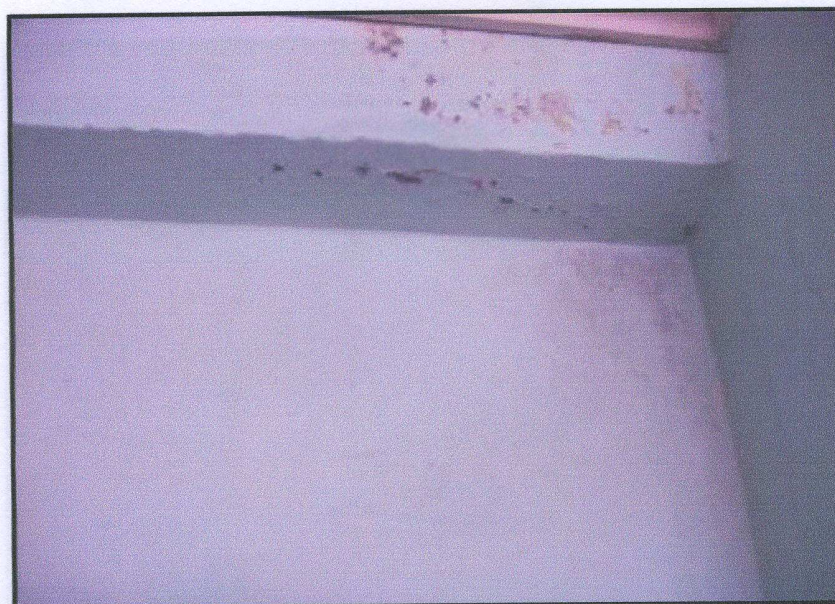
90 – Vista lateral da calha com segregação do concreto.
